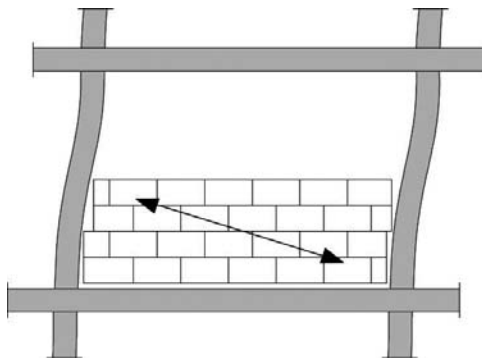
Versagen von Stahlbetonstützen nach einem Erdbeben durch die zusätzlichen Beanspruchungen einer massiven Brüstung
